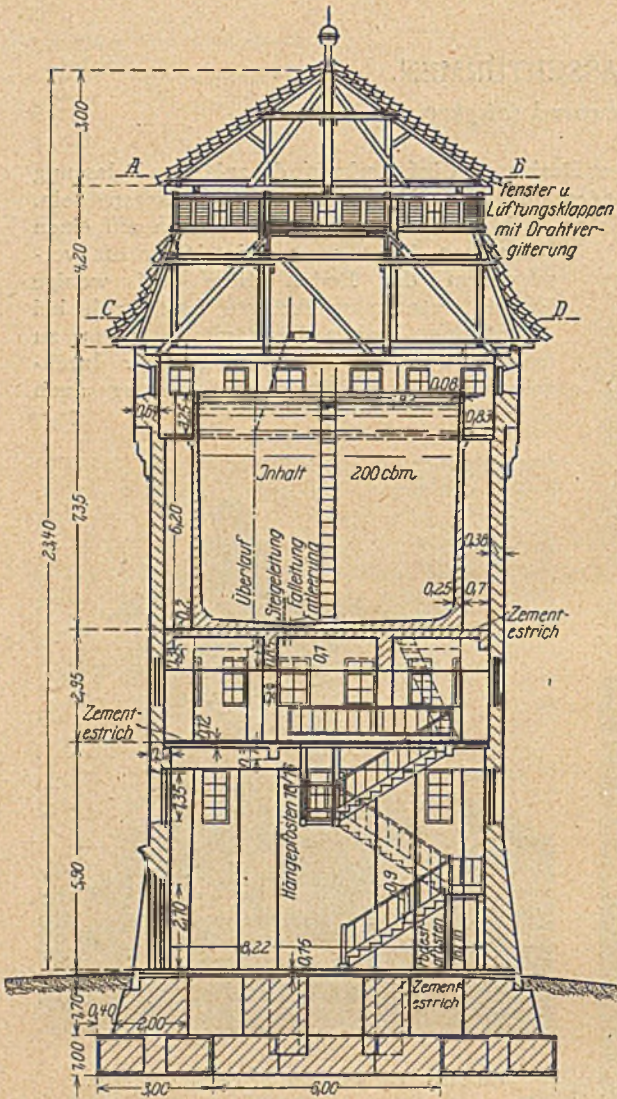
und 7. Wasserturm Pillkallen. Schnitte.
